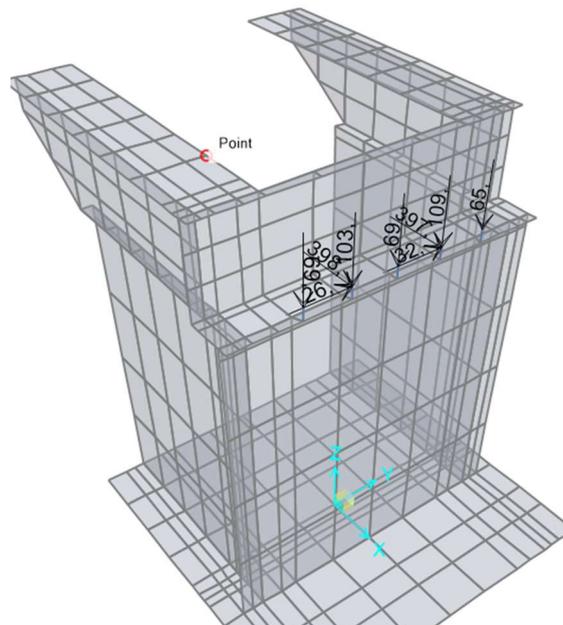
Modello FEM Finale – Vista assometrica carichi sismici in direzione x trasmessi dall'impalcato su spalla fissa (Imp_sis_X)
